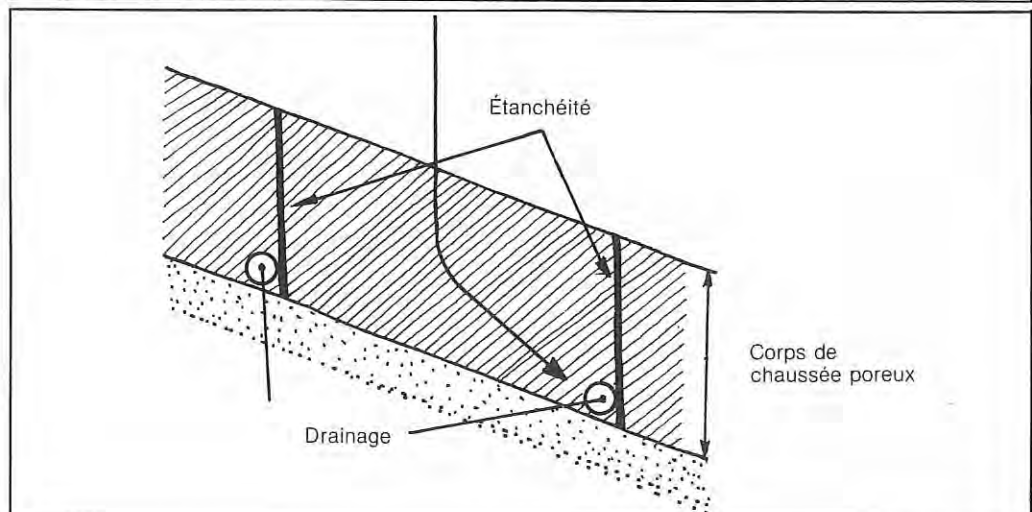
COUPE LONGITUDINALE D'UNE CHAUSSEE POREUSE EN PENTE
